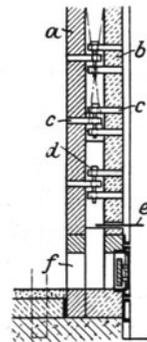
Luftgekühlte Wand der Fuller-Lehigh Co. für Dampfkessel.
